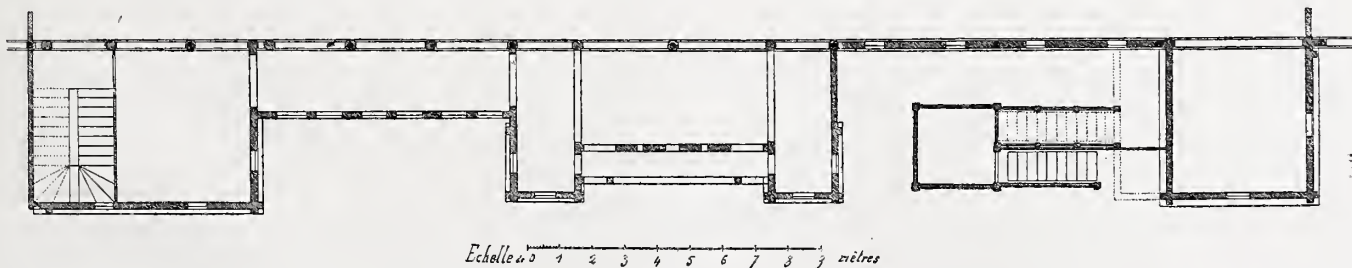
Façade russe, sur la rue des Nations. — Plan du rez de chaussée.
